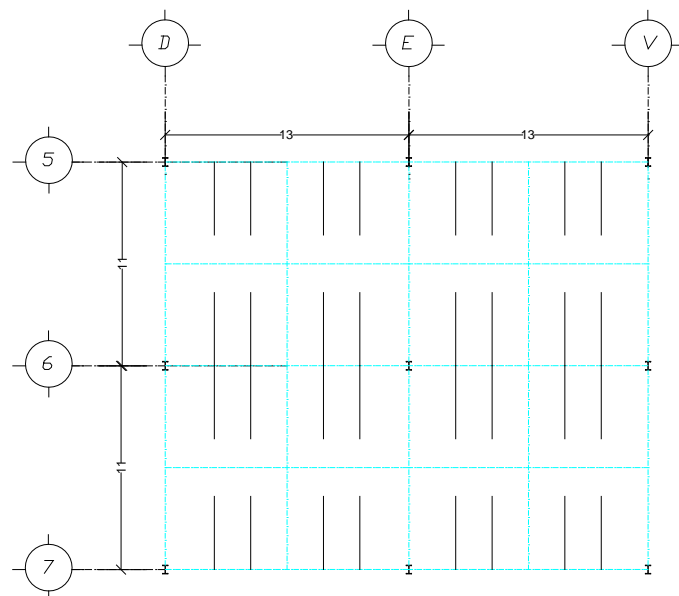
Claro más desfavorable para dimensionar vigas y columnas en estacionamiento
